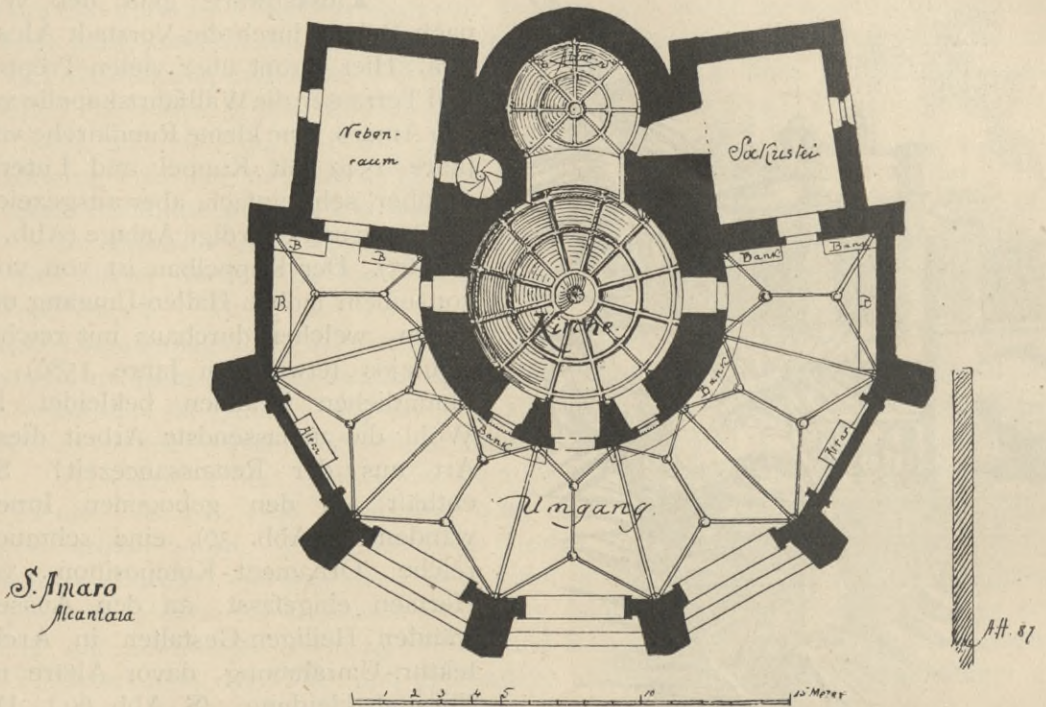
Grundriss der Wallfahrtskirche von São Amaro, Alcantara.
